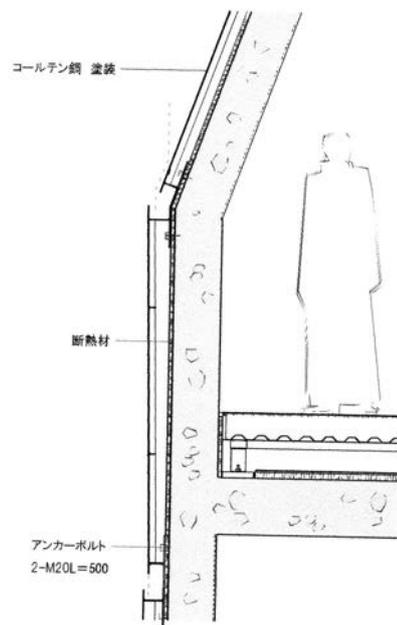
樋となるスリット、アンカーボルトのみ設置の詳細断面図
